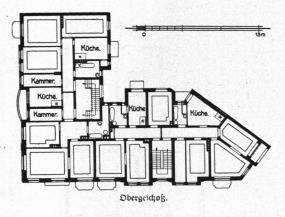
und 1178. Säuferblock Miffundestraße. Architekt Rud. Wöhlecke, B. D. A.
